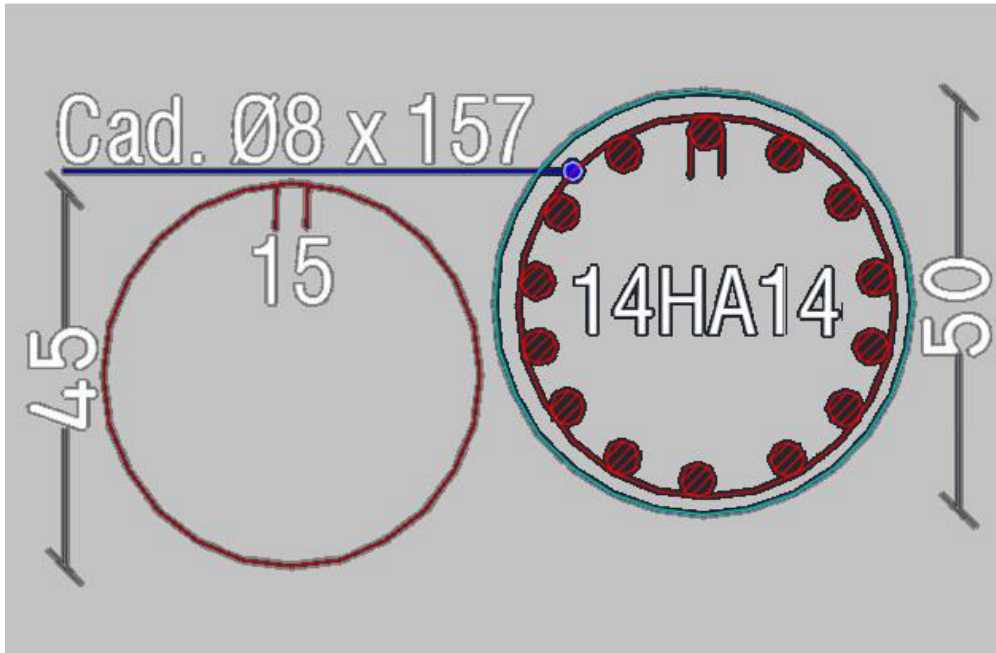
Coupe de ferrailage des poteaux circulaires D = 50cm de niveau RDC.
